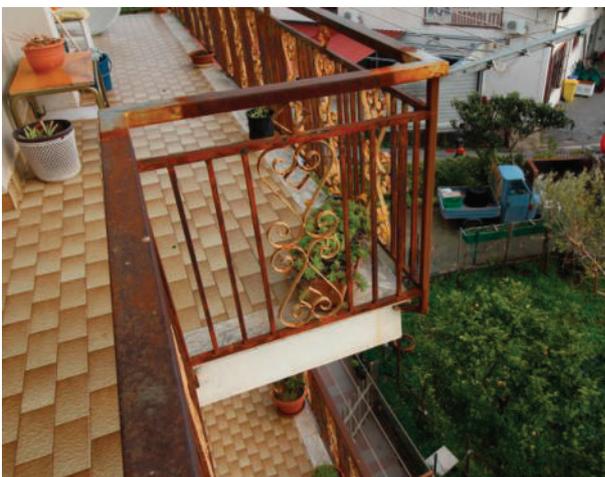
Particolare ringhiere dei balconi arrugginite e rovinate
